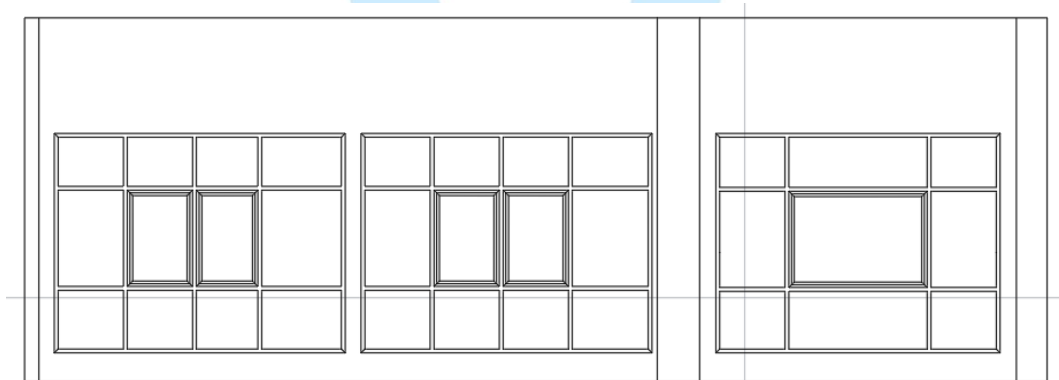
1 Denah pada Ruang Perkuliahan 104F
